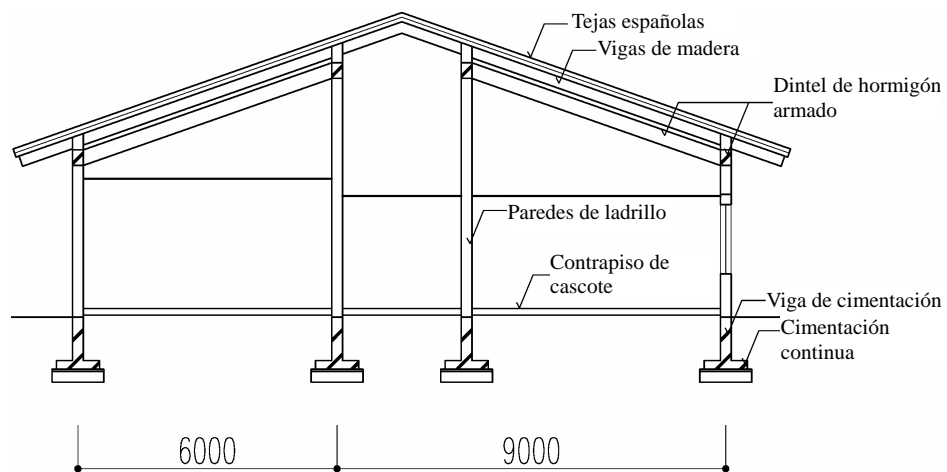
8 Según tipo de estructuras (Sección de una sola planta)
